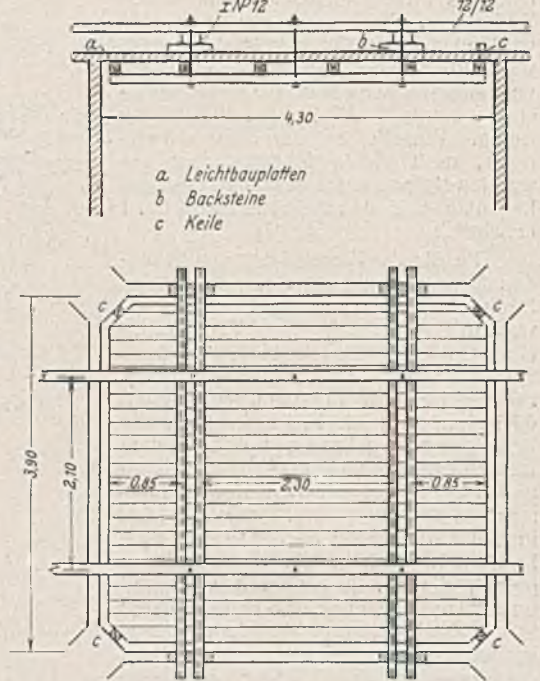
Schalung der Silodecken mit besonderer Hängegerüstung.
